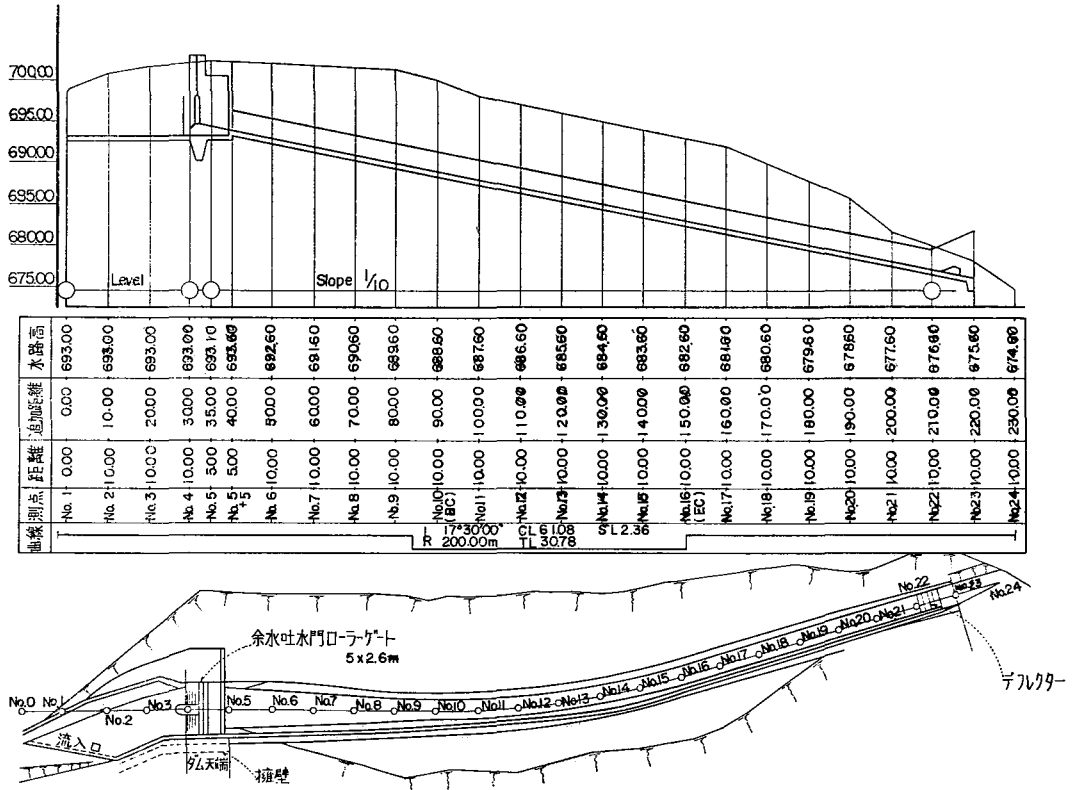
岩洞ダム余水吐平面図および縦断面図
